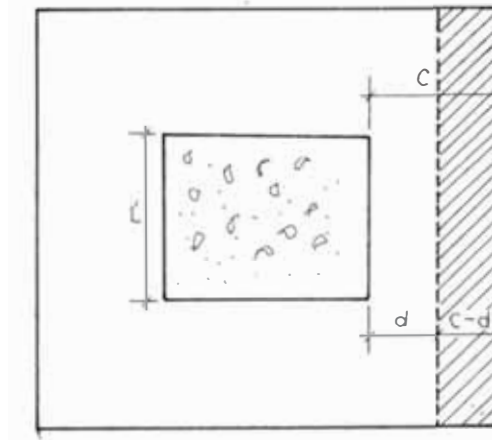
A VISTA DE PLANTA DE UNA ZAPATA DE CIMENTACION
